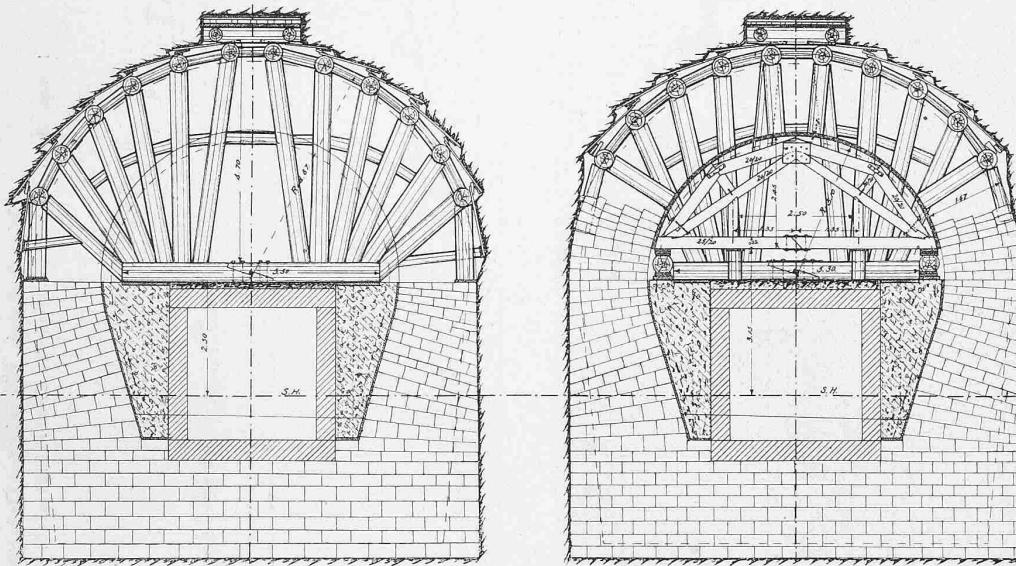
Calotten-Ausbau vollendet. — V. Baustadium. — Abb. 42. Gewölbe-Mauerung. 1:150.
